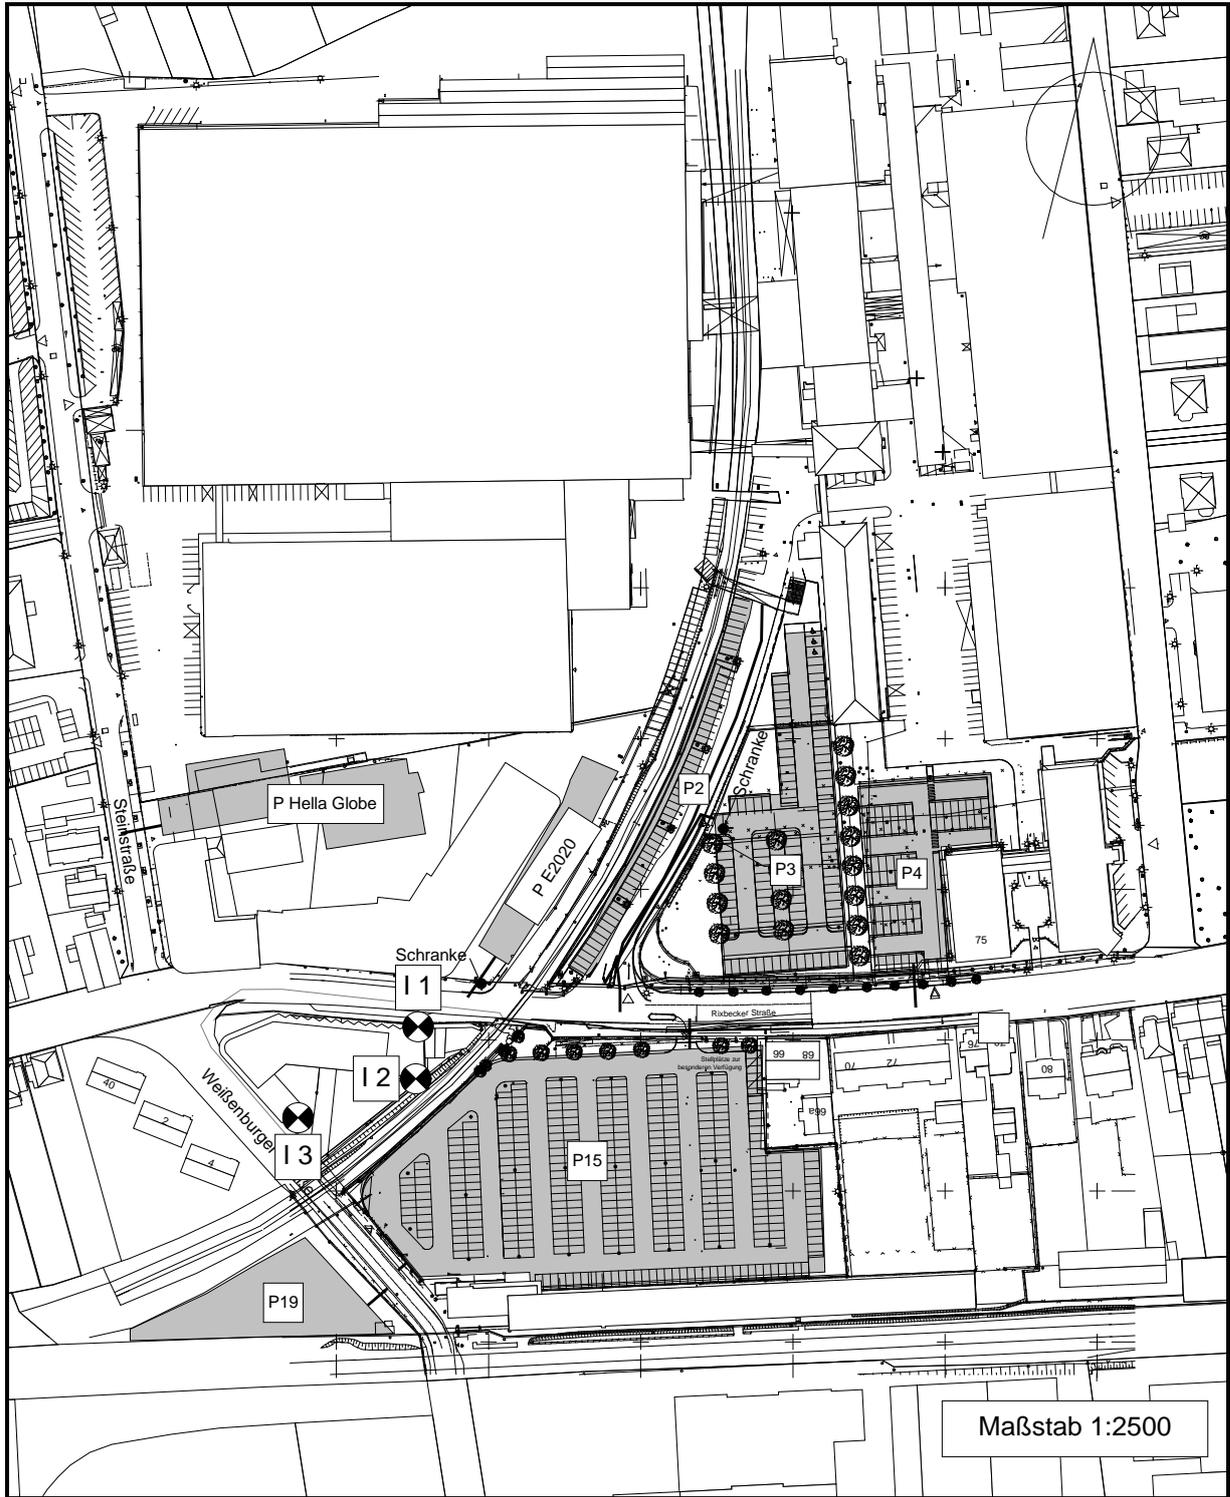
Lageplan Betriebsparkplätze und Immissionsorte „Gewerbelärm“
